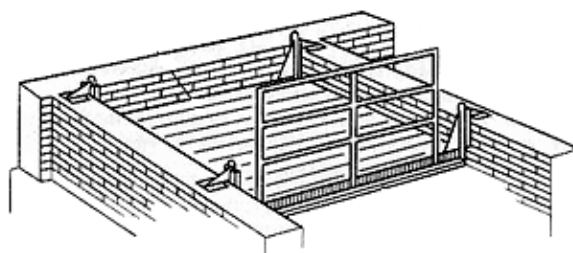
Площадка для кладки стен лестничной клетки
